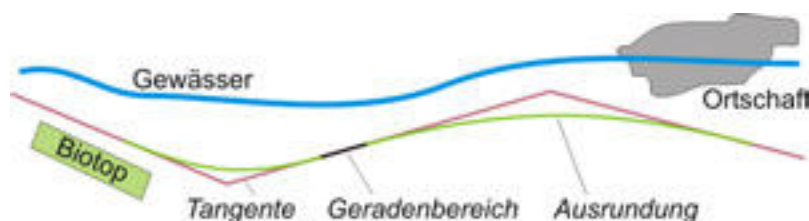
Tangentenentwurf zur Modellierung der Achse im Lageplan
